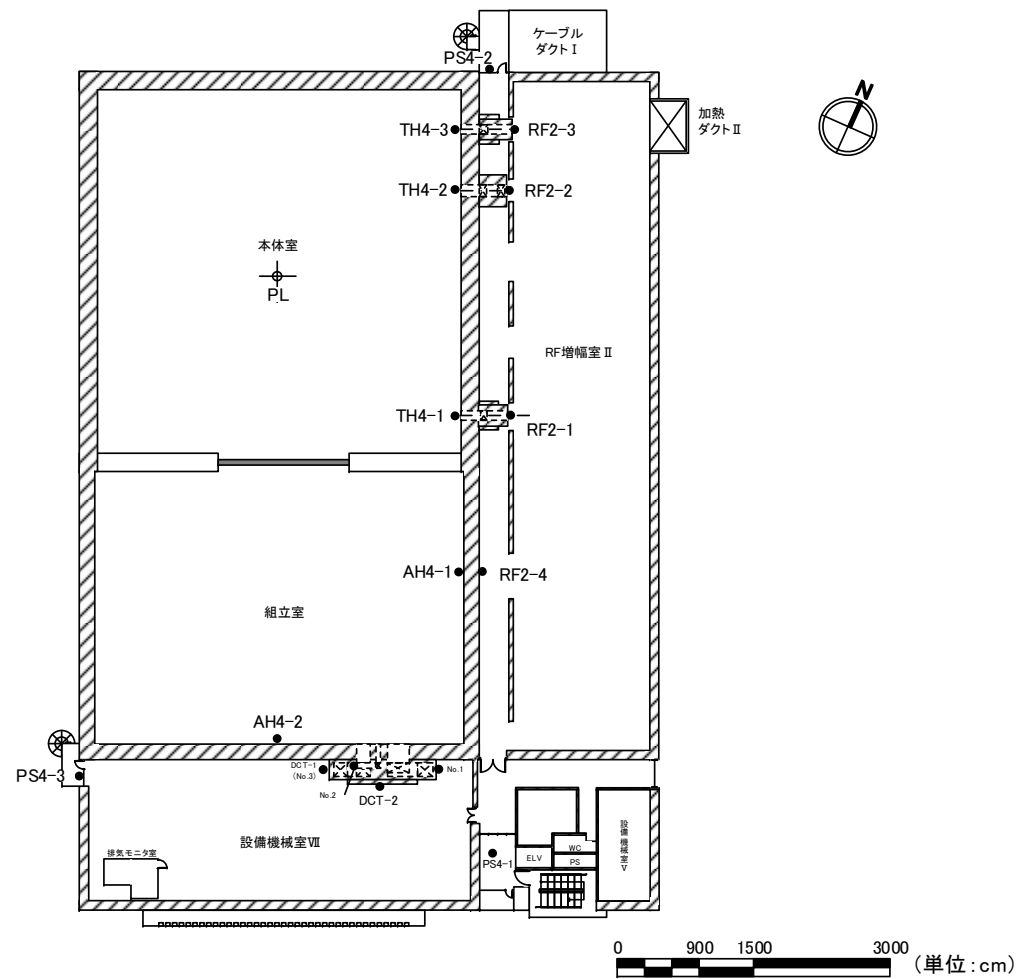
1. 5. 4 JT-60実験棟4階平面図 (単位: cm)
